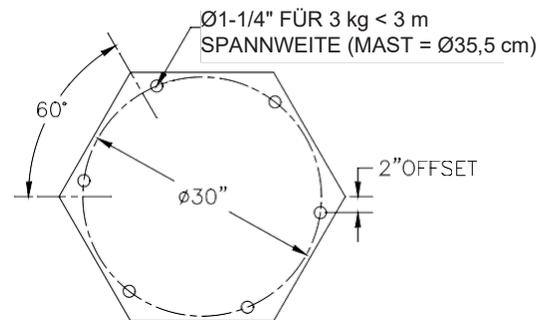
D. Sockelbolzenmuster mit 6 Bolzen.
